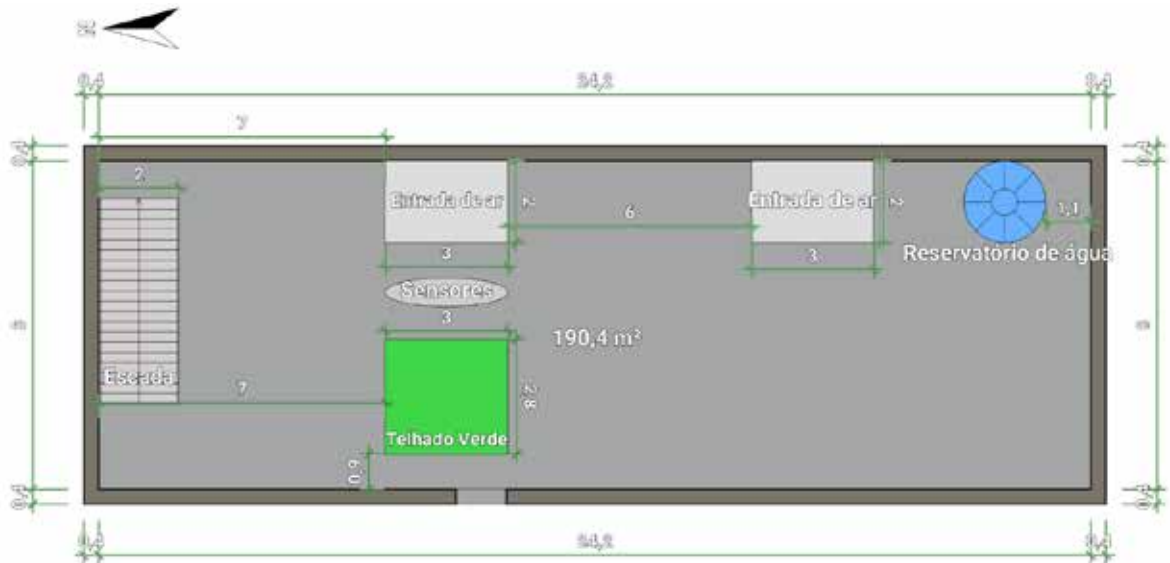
Croqui da área experimental onde foi instalado o telhado verde e laje, unidade em metros (m), escala 1:100, Serra Talhada, PE, 2016.
